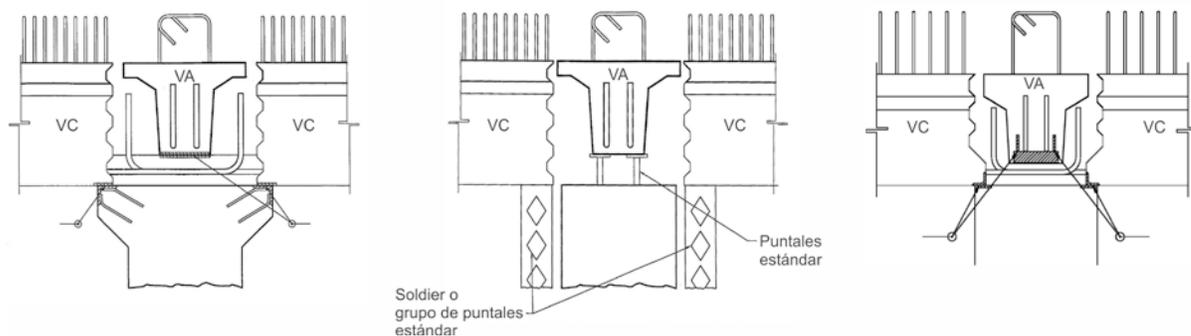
Sistemas de apoyo temporal de vigas en columnas
